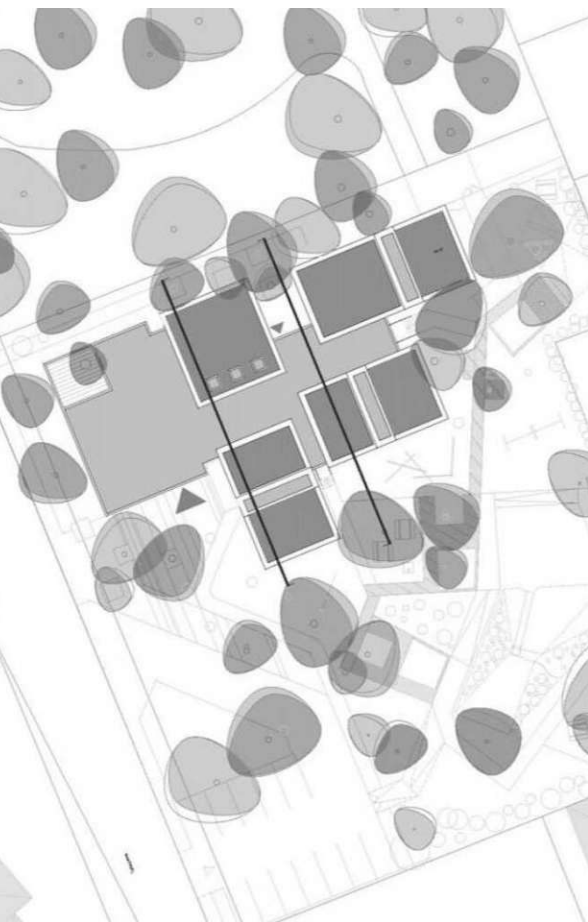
Lageplan Kindergarten Guntramsdorf (o.)
